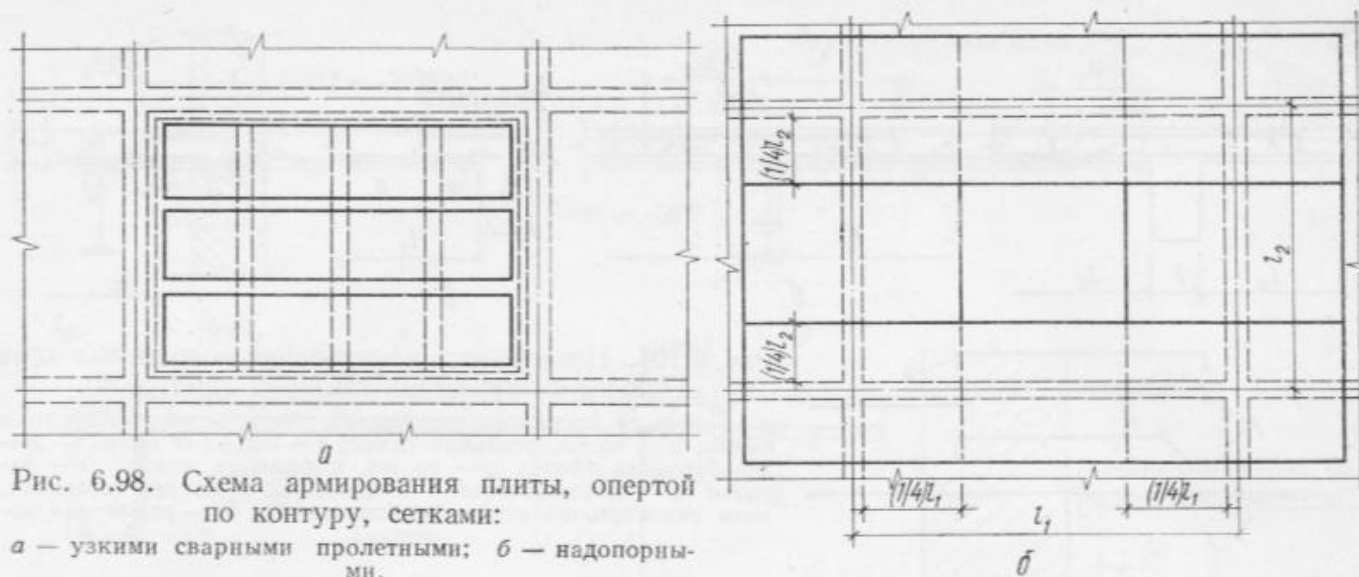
Схема армирования плиты, опёртой по контуру, сетками:
